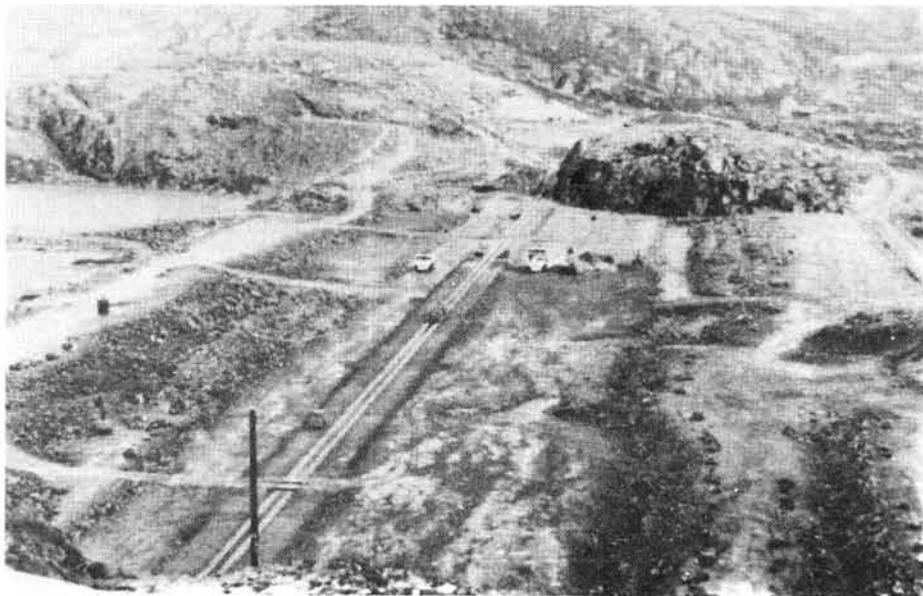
Barragem de Storvass durante a construção (Venkatachalam, 1984)
